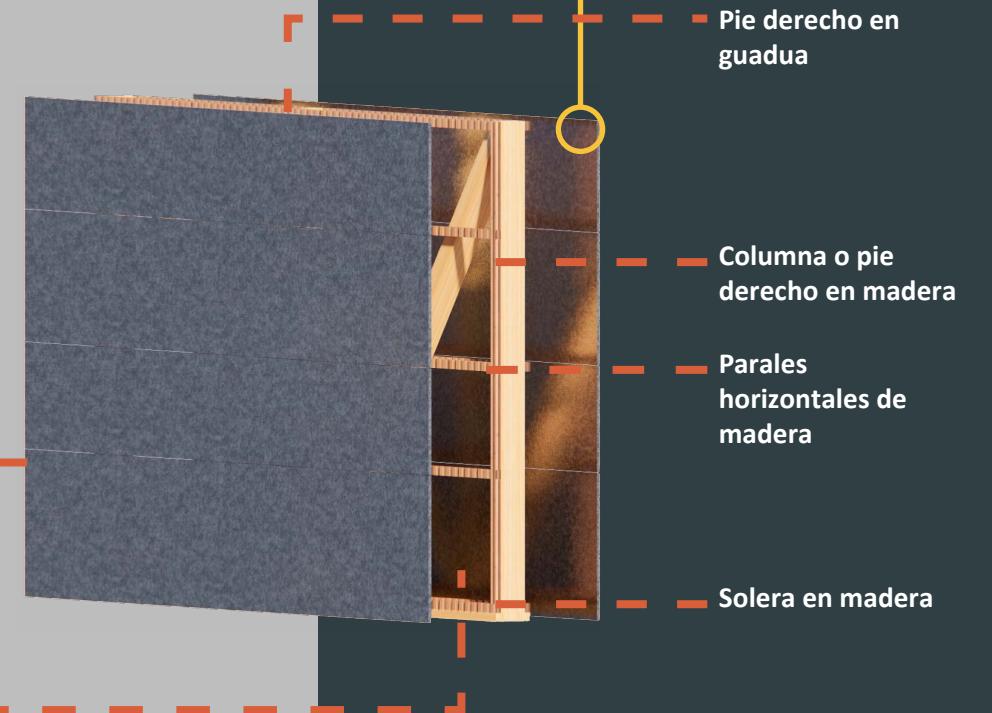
[Figura] Estructura del bahareque metálico. Fuente: Autor.
